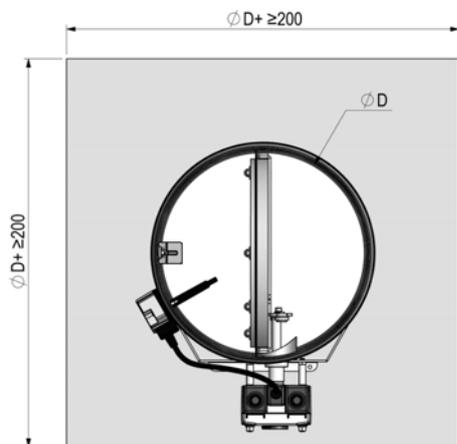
Einbau in massive Decken mit Betonsockel, Draufsicht
